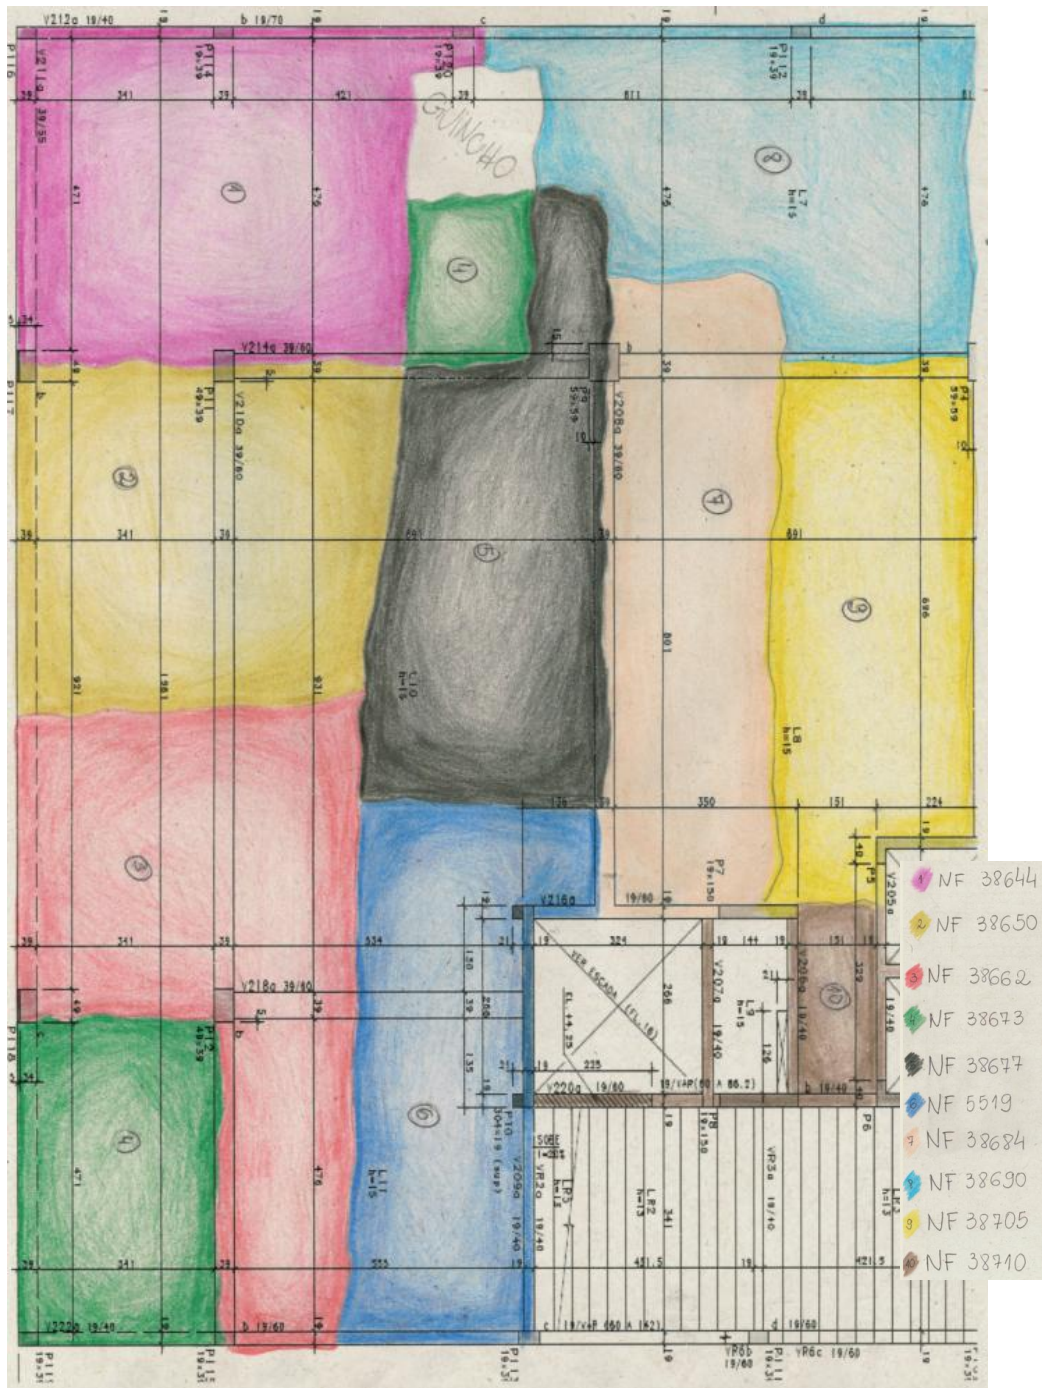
6 - Rastreamento do concreto - 2ª Laje (Parte 2)
